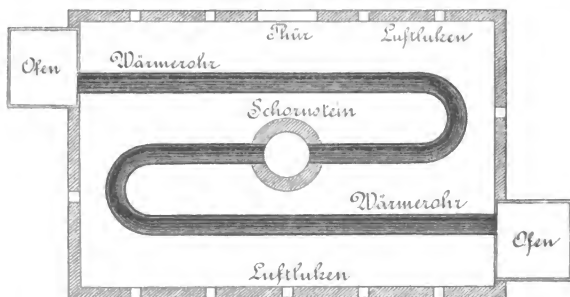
Grundriss eines Trockenhauses mit zwei Öfen und einem Schornstein in der Mitte.
